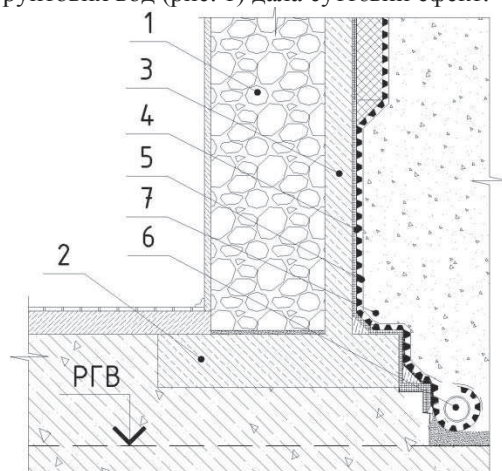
Схема підсилення фундаментів за допомогою збільшення опорної площі та односторонніх бенкетів: 1 – існуючий фундамент; 2 – монолітна залізобетонна плита; 3 – залізобетонна стінка (бенкет); 4 – шиповидна гідроізолююча мембрана; 5 – геотекстиль; 6 – дренажна труба; 7 – ґрунт зворотної засипки.
